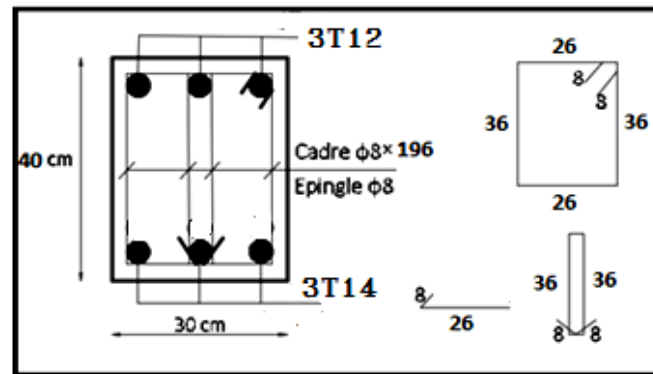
Dessin de ferrailage de la poutre brisée en travée
